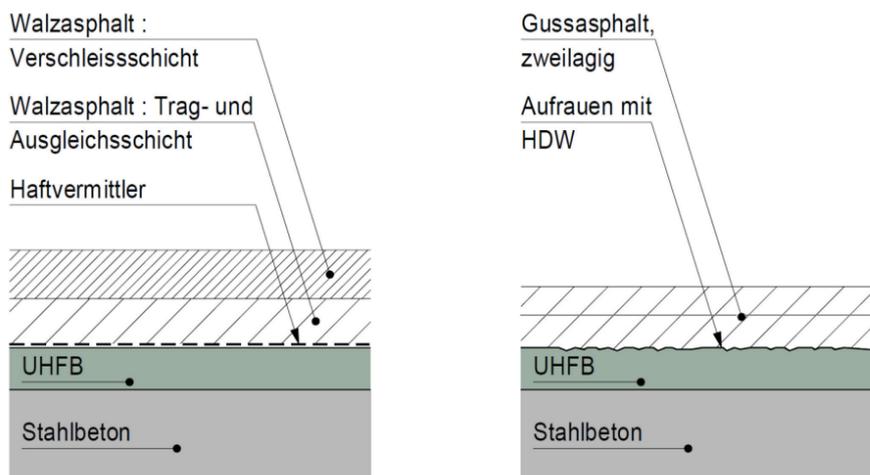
Belag aus Walzasphalt oder Gussasphalt auf UHFB
